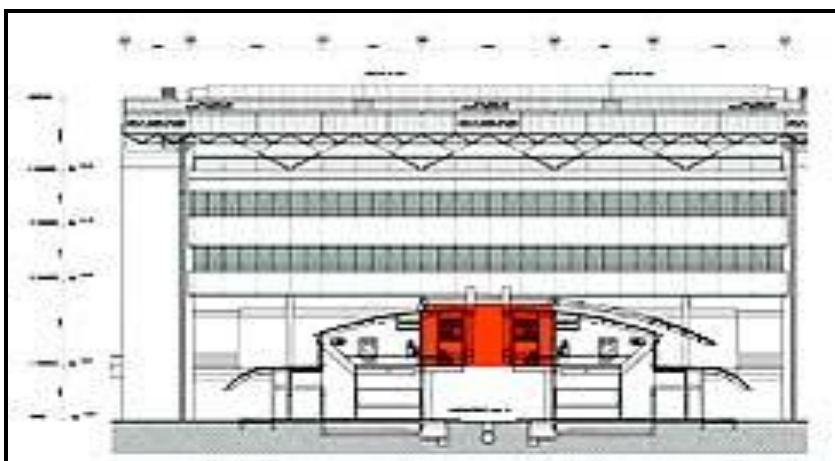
Corte Transversal do laboratório com locação Leste-Oeste dos pipe-racks [B]
